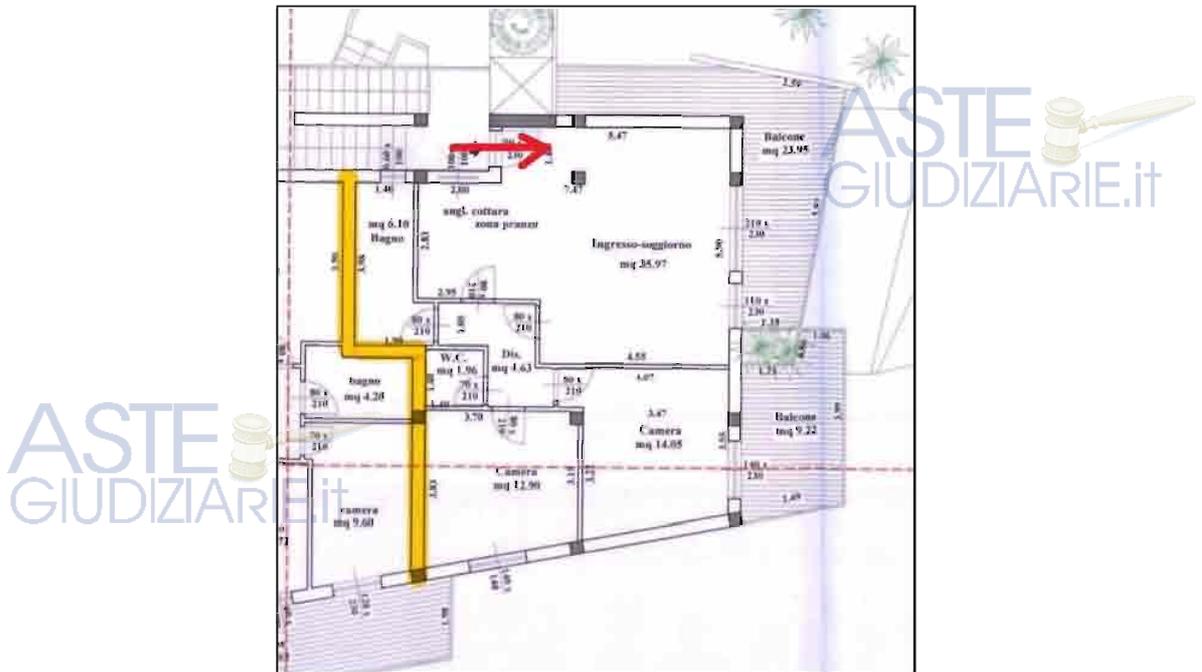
Immobile A\_21, appartamento piano 1° (Planimetria di progetto)
